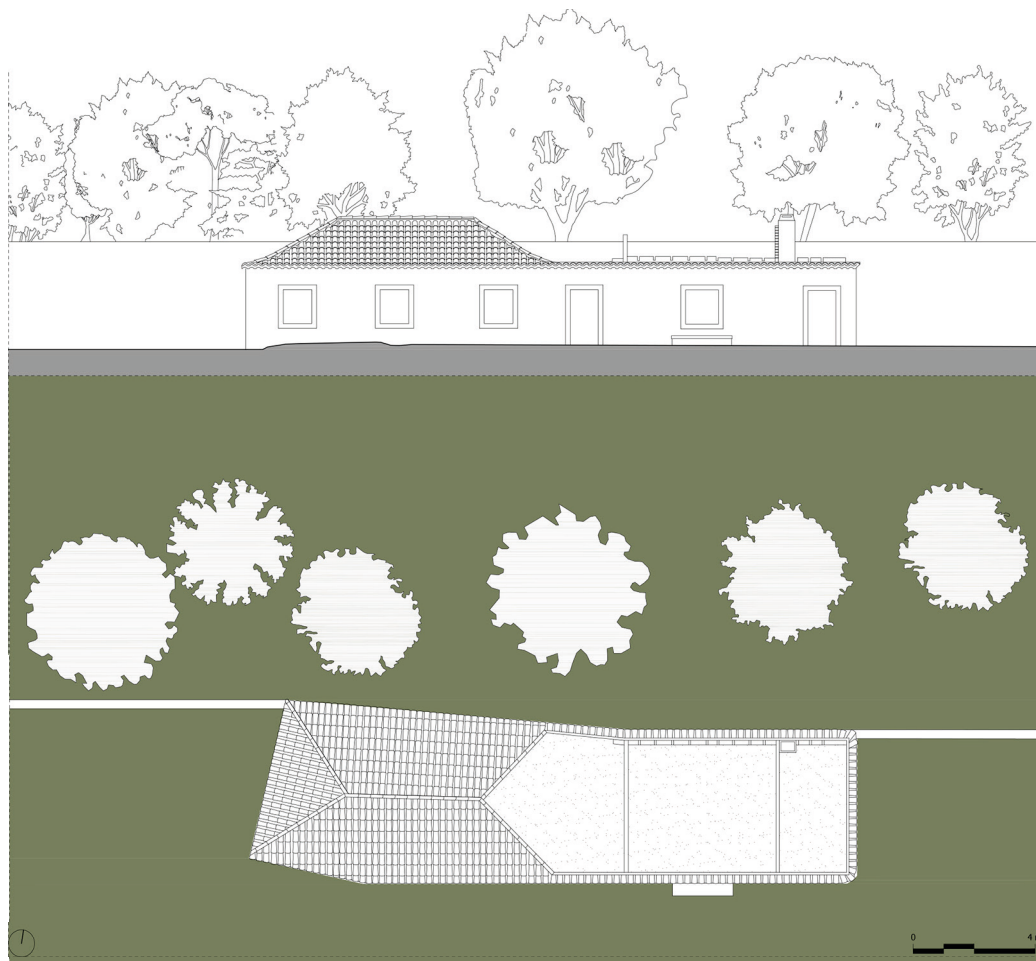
La Quinta da Ribafria. Pianta delle coperture e prospetto sud della stalla.
